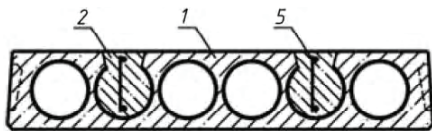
Замоноличивание в пустотных каналах дополнительных арматурных каркасов: 1 – усиливаемая плита; 2 – монолитный бетон; 5 – дополнительный арматурный каркас.
